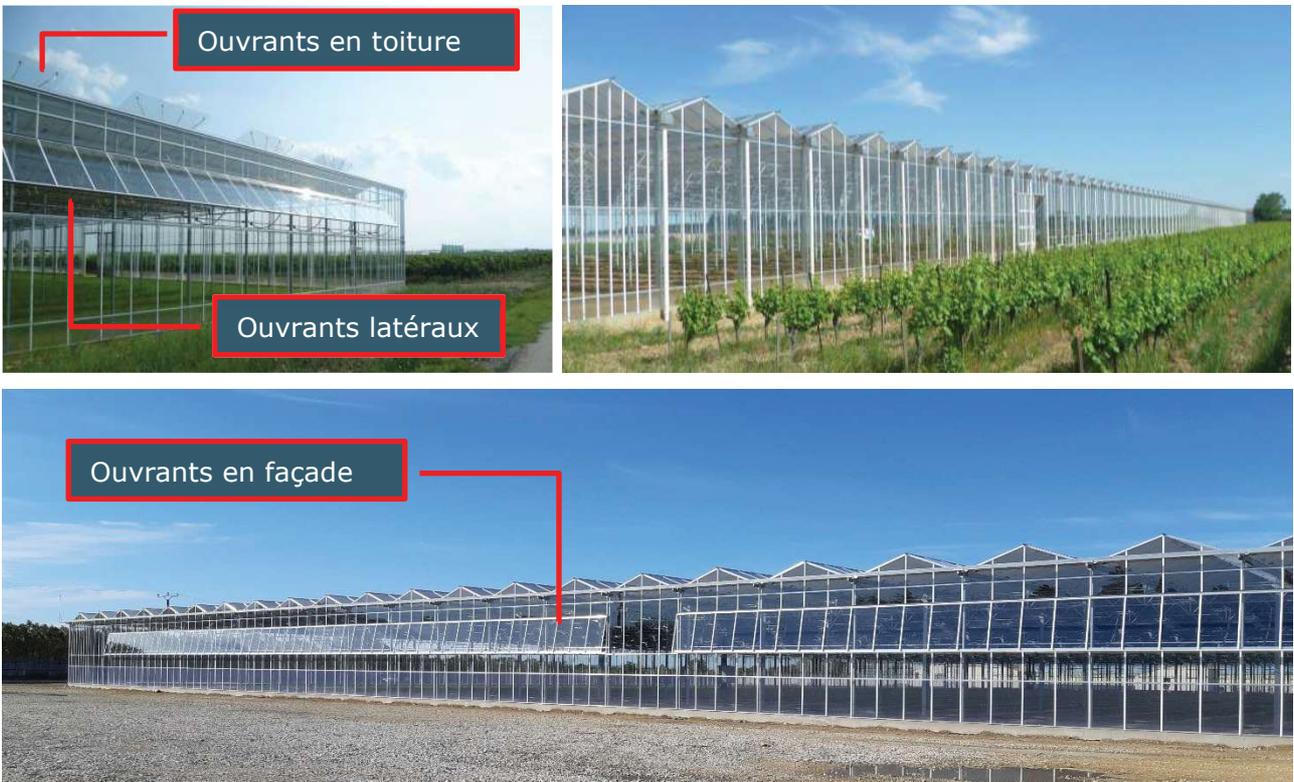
Ouvrants en façade et en toiture (source : Reden).
